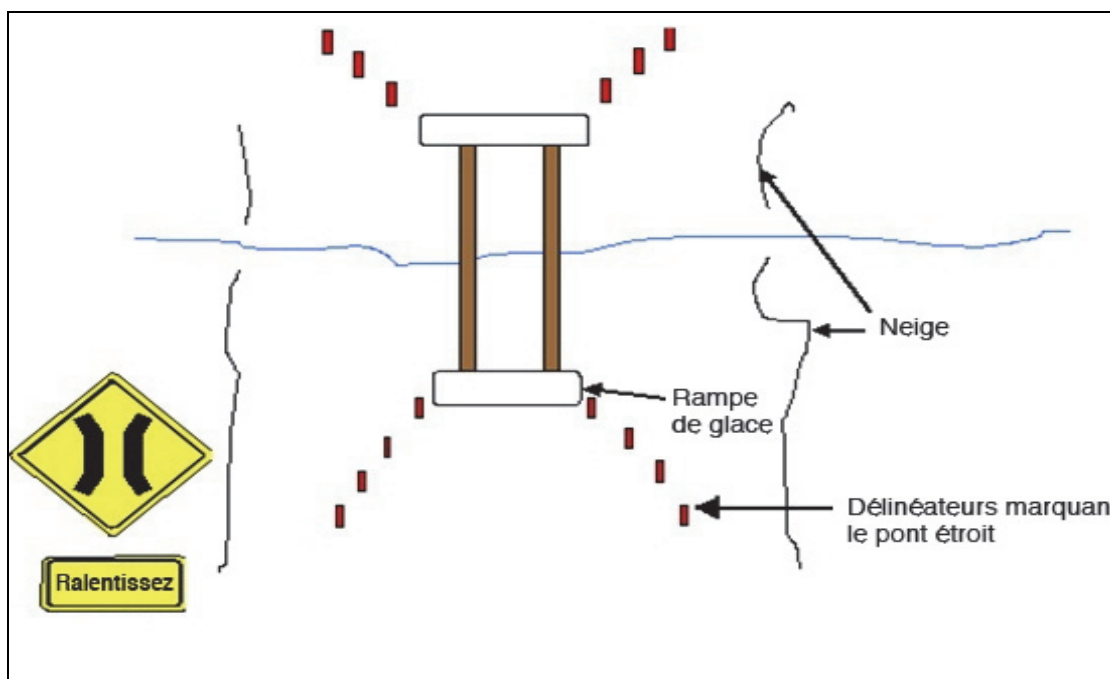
Vue en plan d'une traverse (Source : SMHI 2008)
